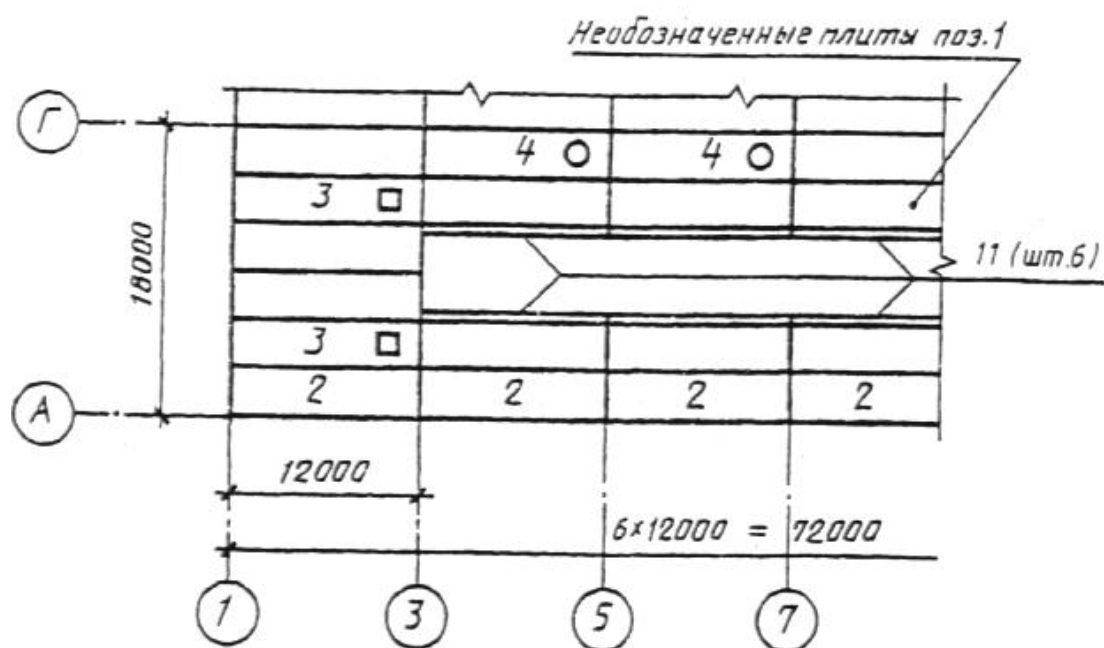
Схема расположения плит покрытия (перекрытия)
